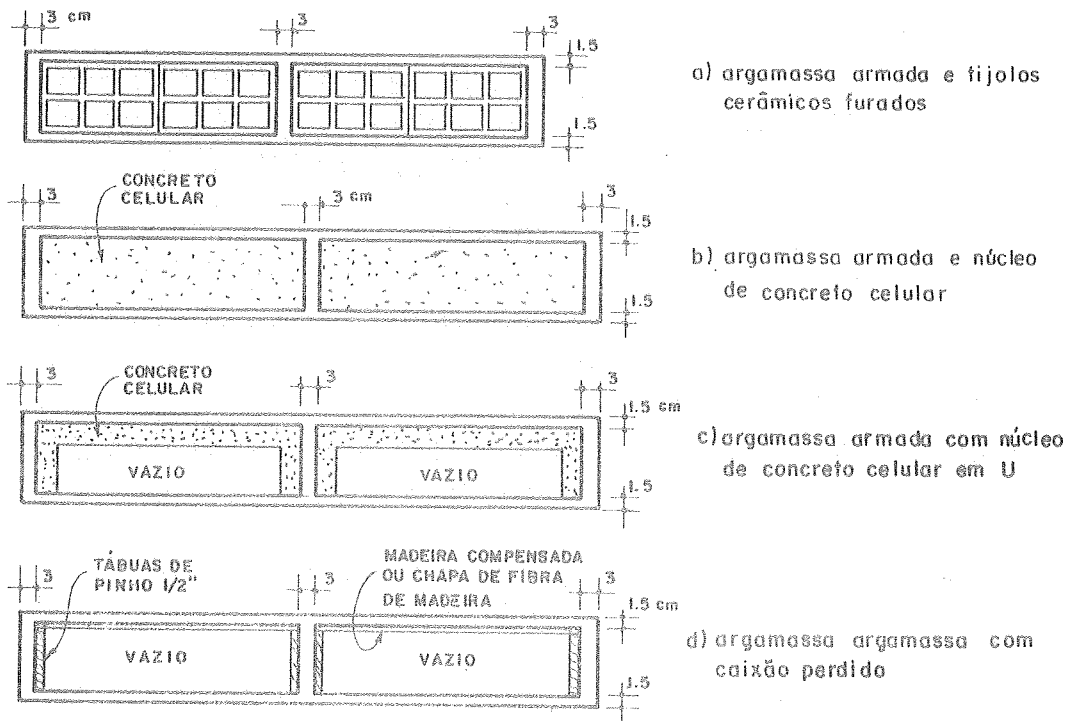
ESTUDOS PARA APLICAÇÃO EM LAJES DE PISO.¹⁸⁶
